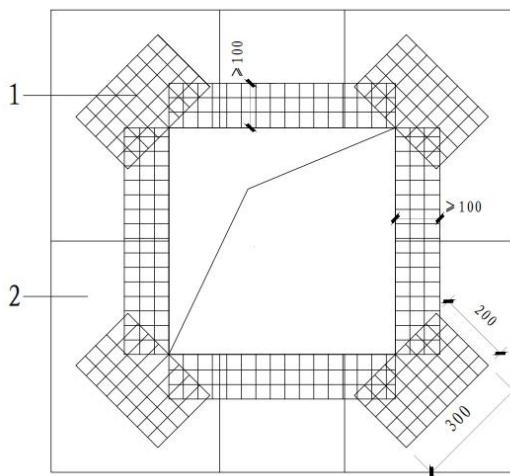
门窗洞口部位玻璃纤维网布增强示意图
